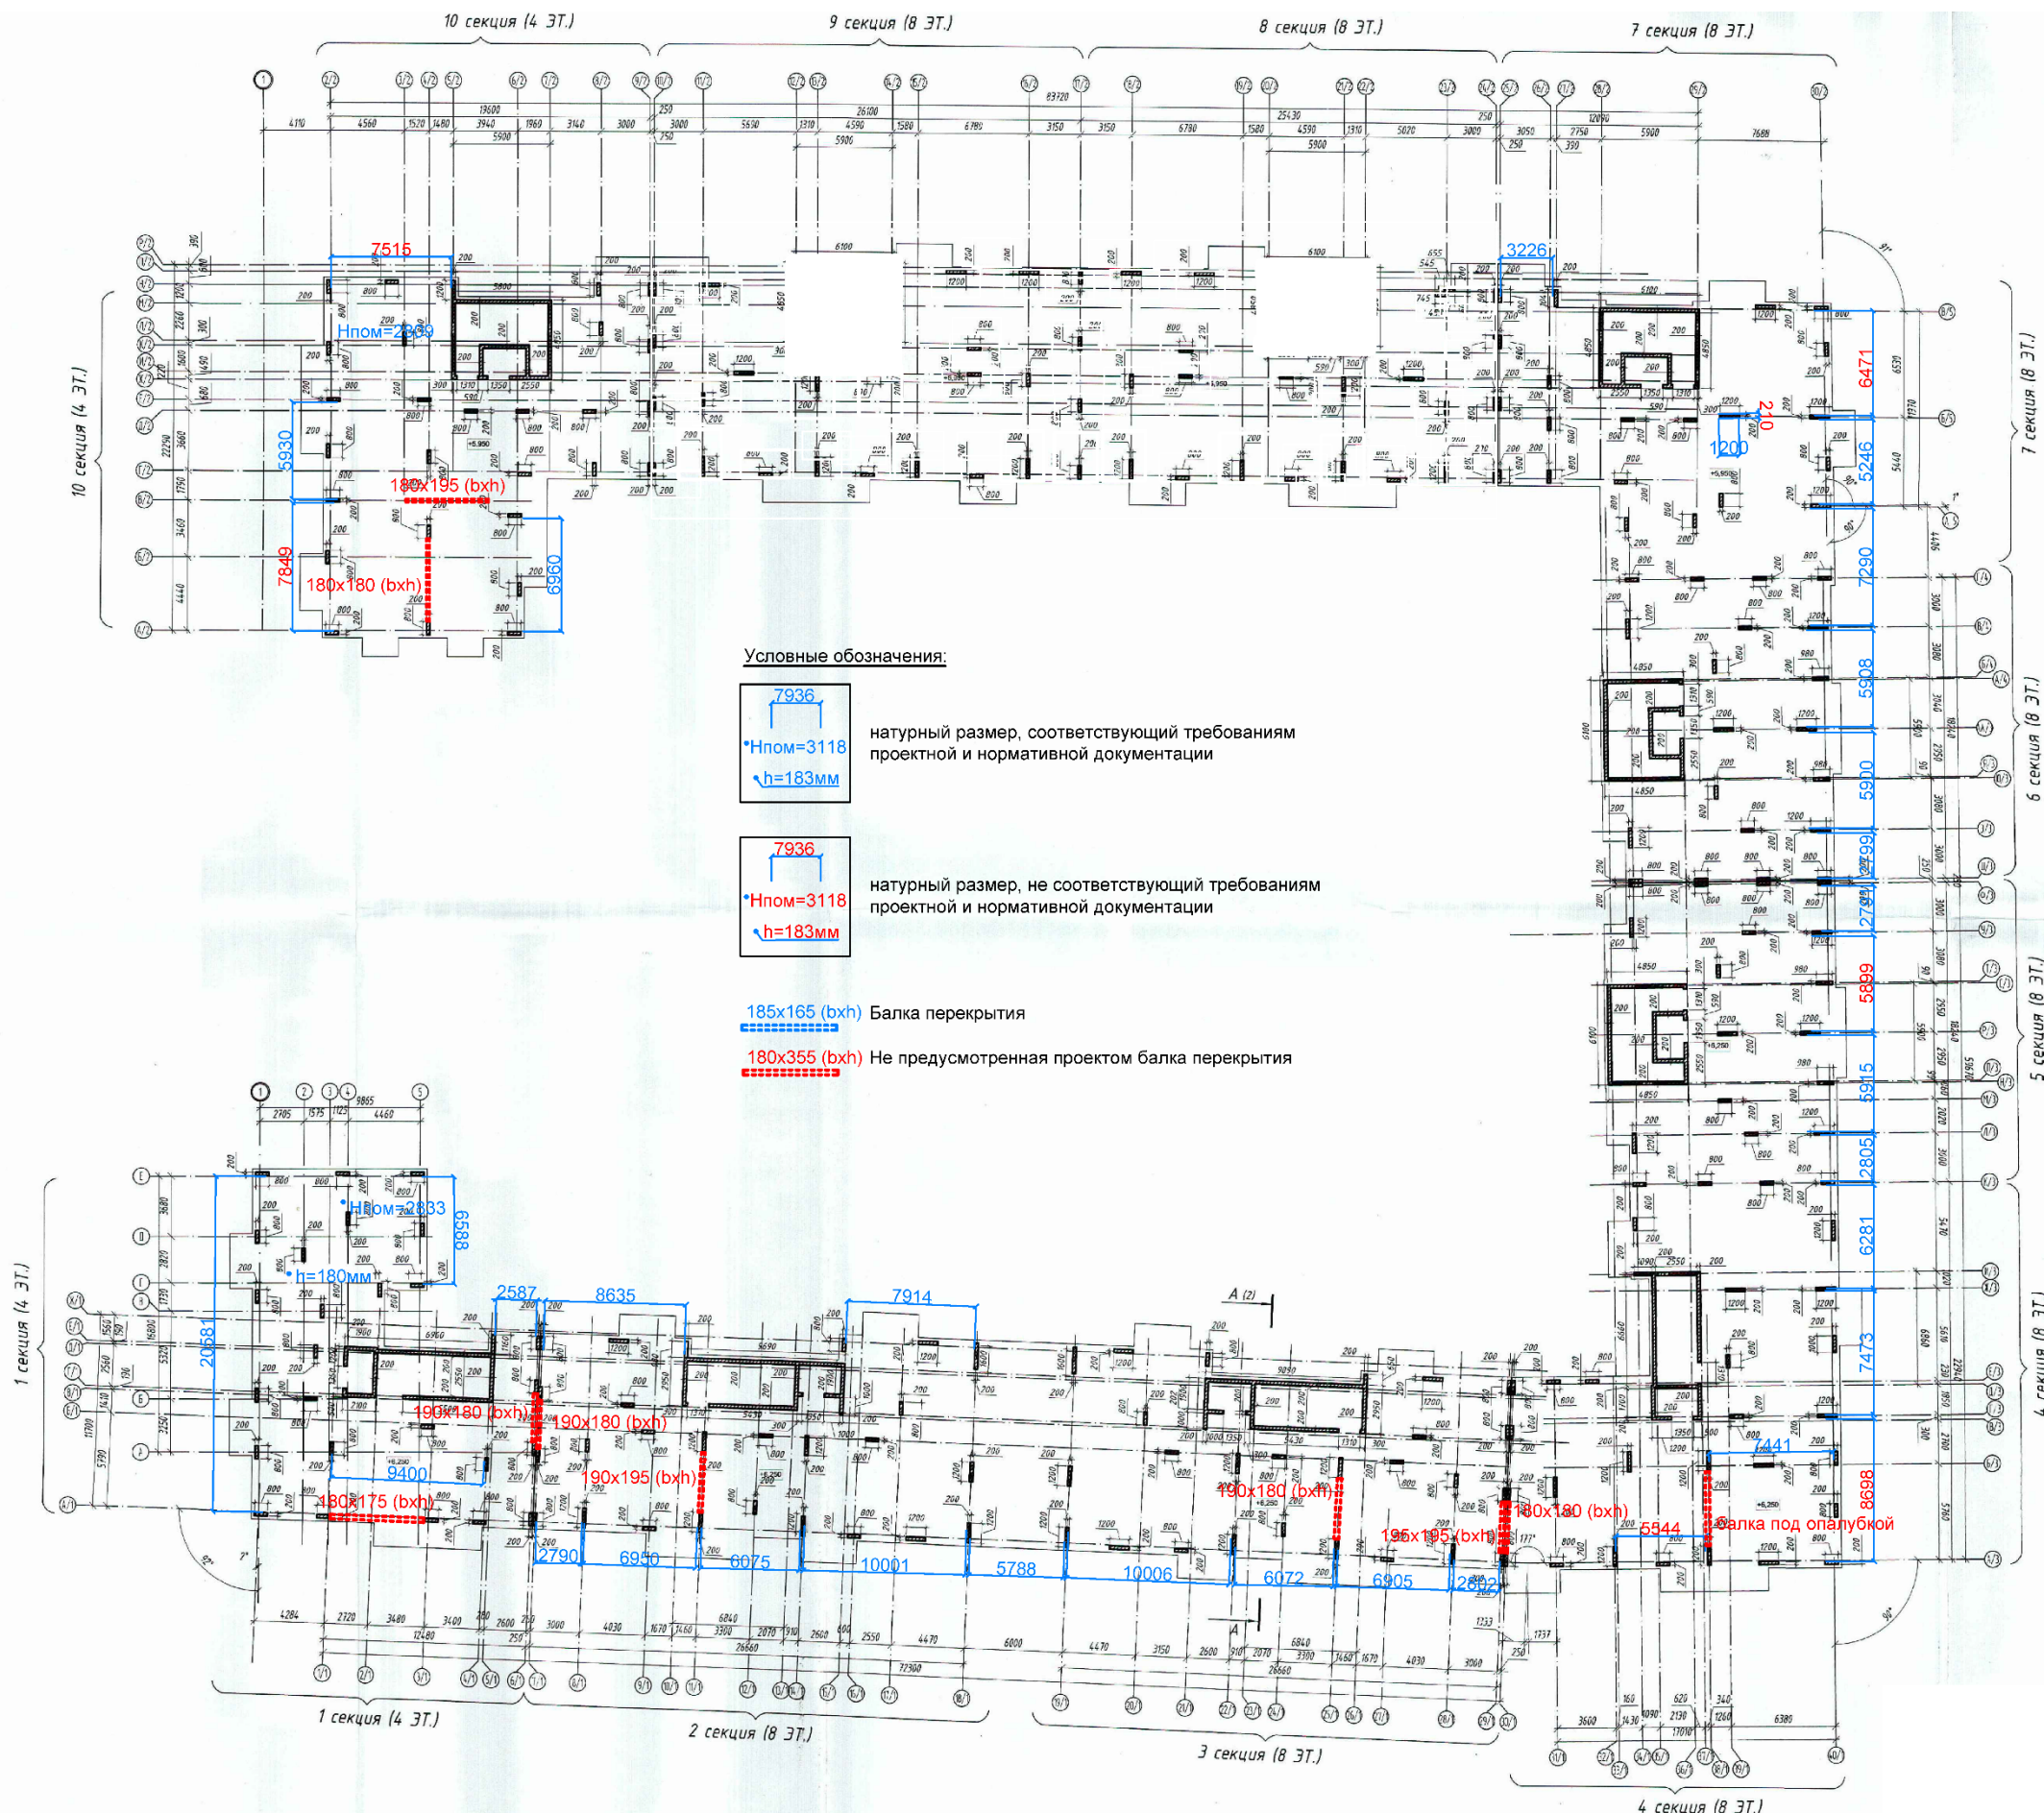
Обмерный план плиты перекрытия второго этажа и вертикальных монолитных конструкций третьего этажа
